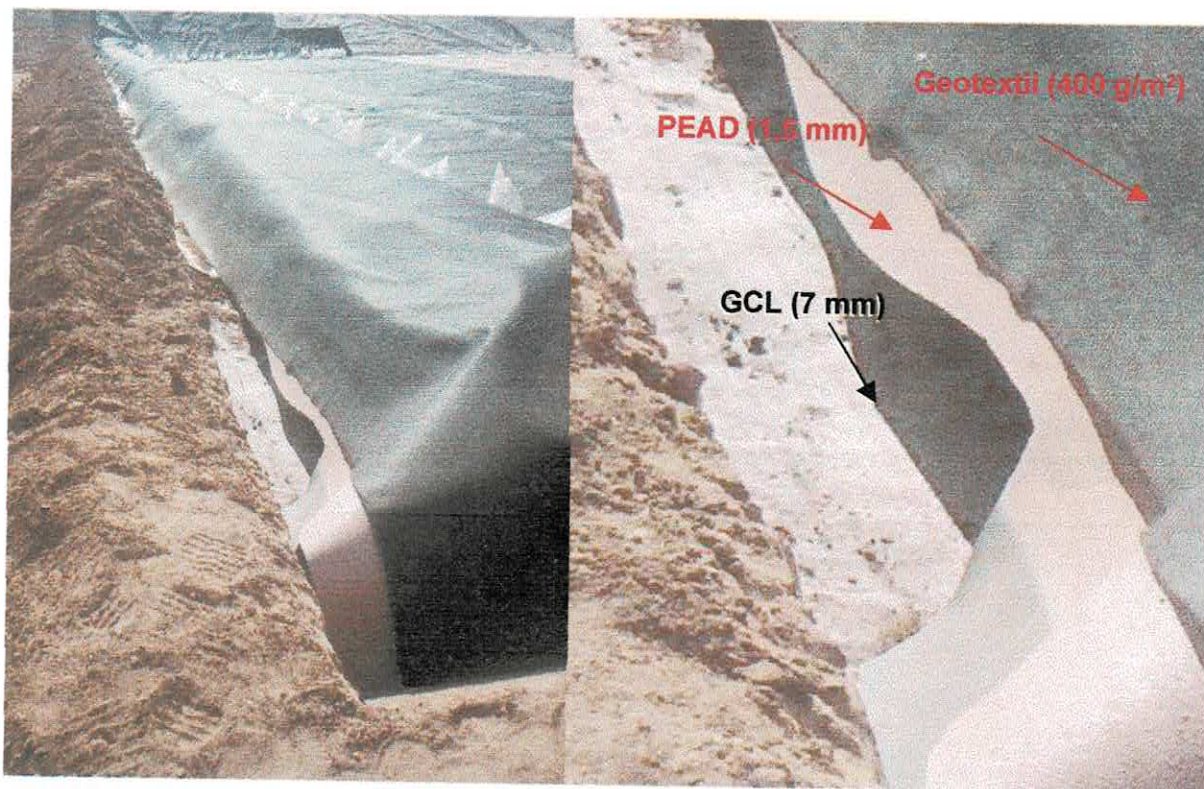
Anclaje de la Geomembrana en Zanja lateral y Detalle (18.04.2005).
